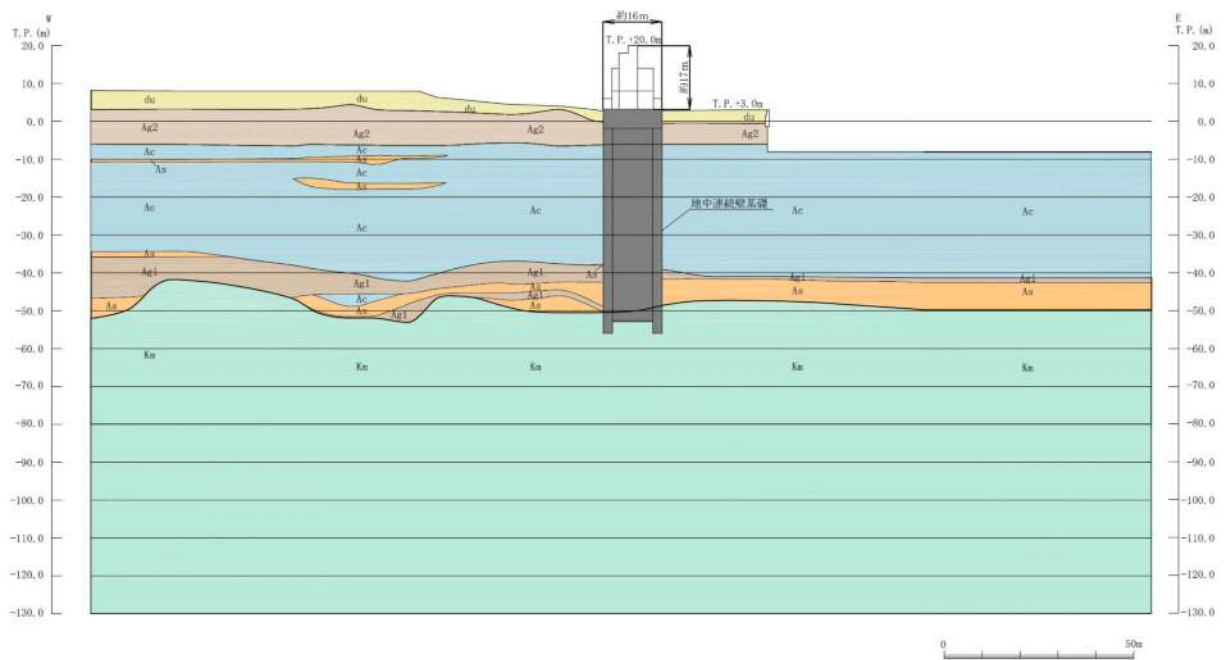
(2) 鋼製防護壁評価対象断面図 (②-②断面)
